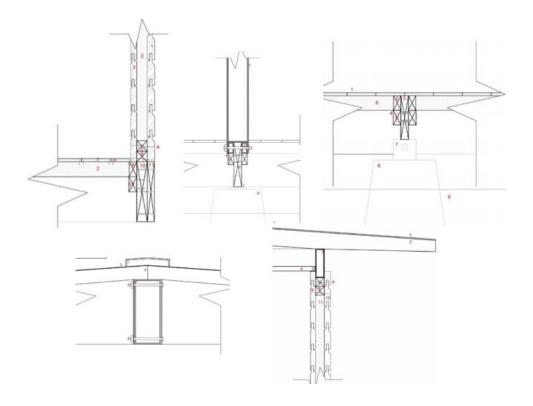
Detalles de uniones de piso a muro, de muro a techo, de unión de tejas a viga aérea.
